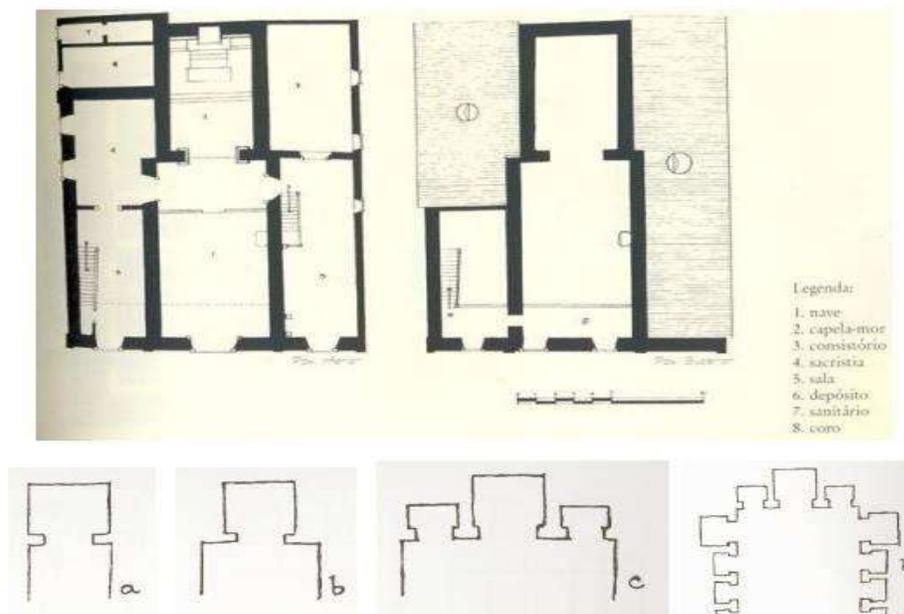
Planta baixa da Igreja São Francisco de Paula
